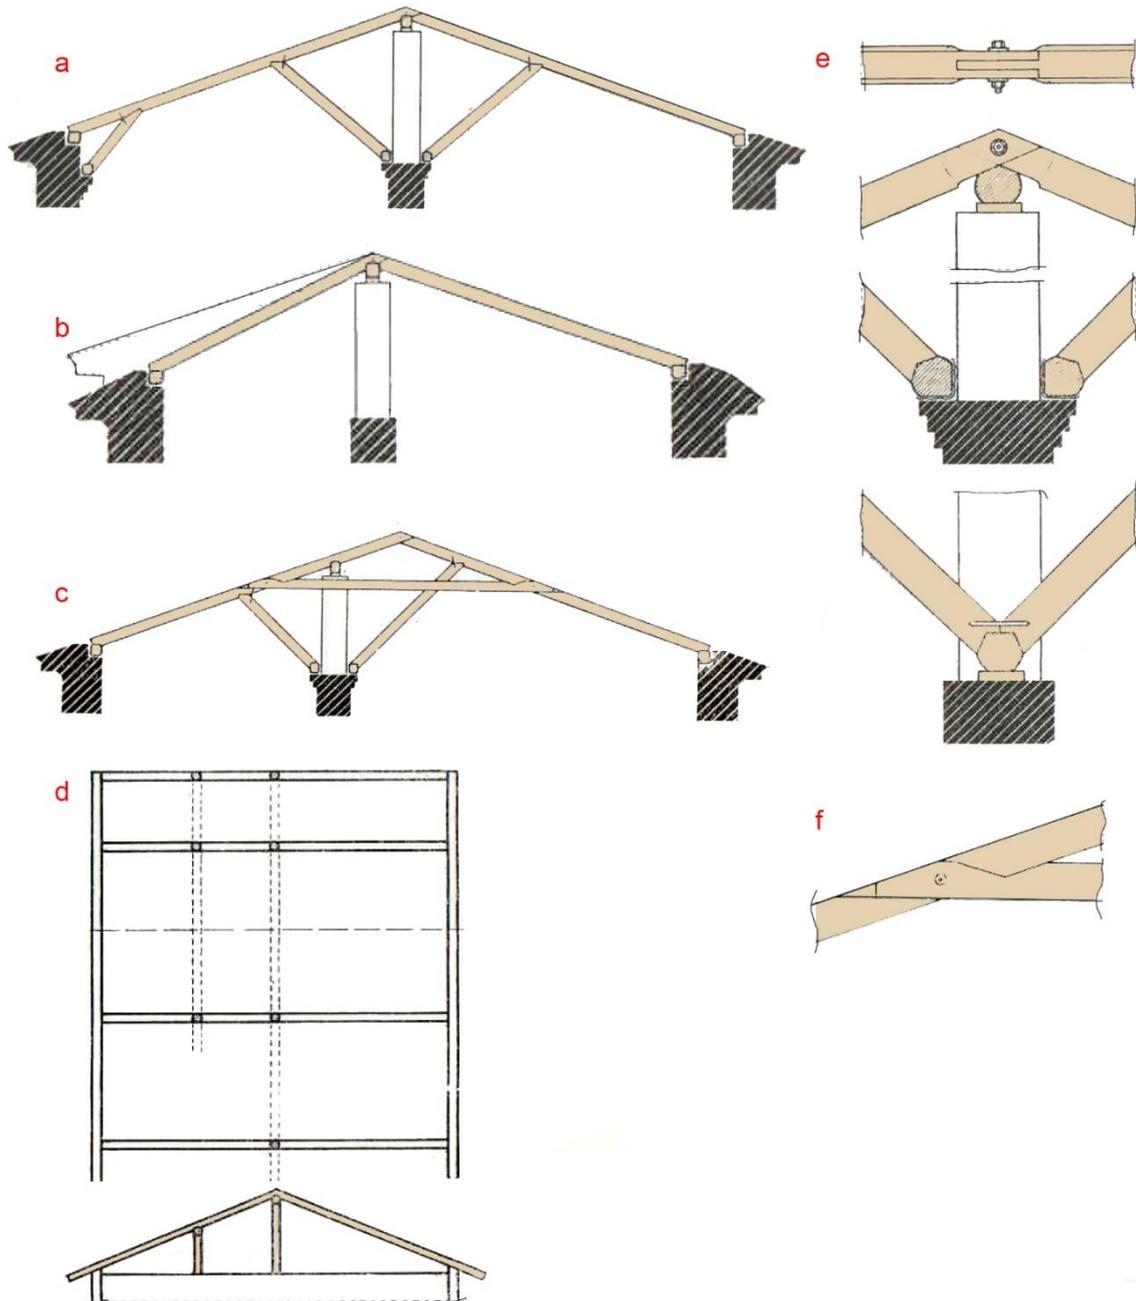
Наслонные стропила двускатных крыш: а – стропила с подкосами при пролетах более 5 м; б – неравностатная крыша со скатами разного уклона или разной длины; с – стропила с соединением ног в коньке без опорного элемента; д – стропила при двух внутренних продольных стенах; е-ф – узловые соединения элементов стропильной системы [33]
